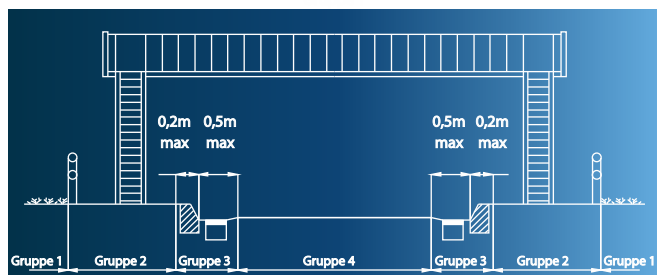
Typischer Querschnitt einer Straße mit Darstellung der Lage der Gruppen
